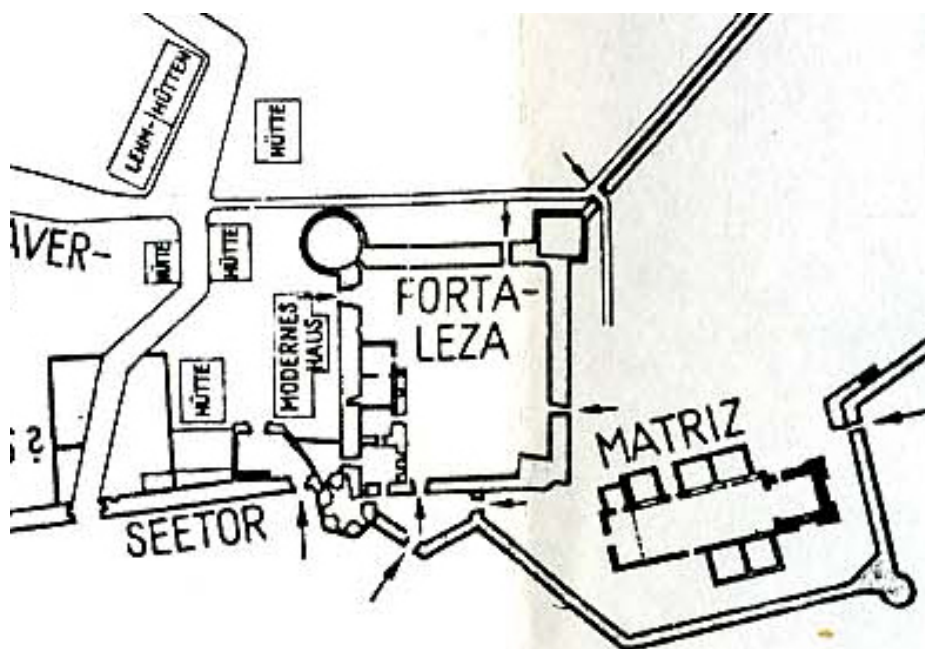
Chaul, pormenor da planta da fortaleza manuelina (© Mitterwallner, *Chaul...*, 1964)
